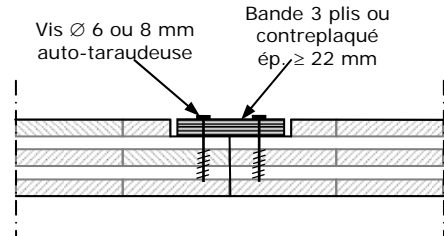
Assemblage par interposition d'une bande de liaison (joint languette)
